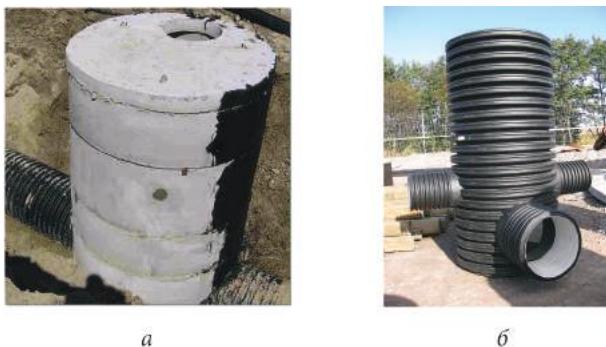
Смотровые колодцы: *а* — из сборных железобетонных колец; *б* — из пластика
